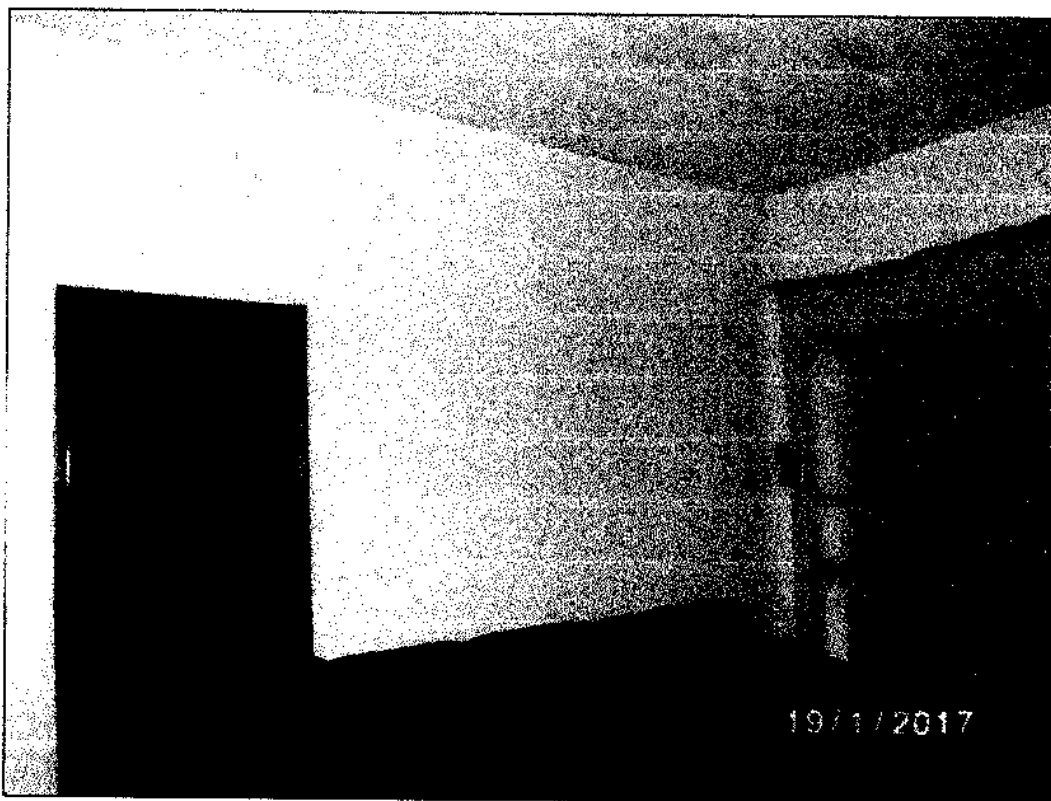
VISTA INTERNA DA SALA DA SEDE
